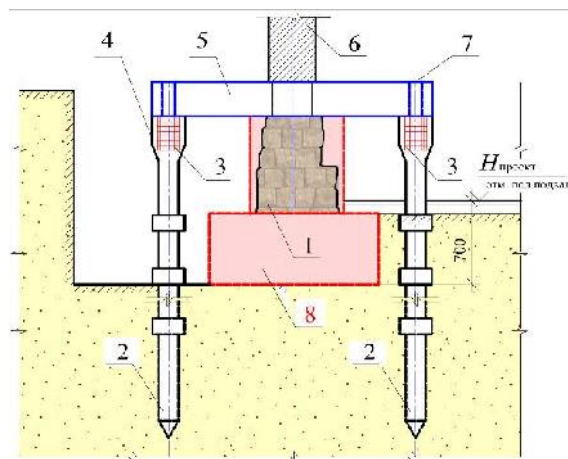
Заглубление ленточного фундамента с помощью выносных вдавливаемых свай: 1 – существующий фундамент; 2 – металлические трубчатые сваи; 3 – арматурный каркас оголовка сваи; 4 – оголовок; 5 – железобетонная балка; 6 – стена; 7 – отверстие; 8 – проектируемый заглубленный фундамент
